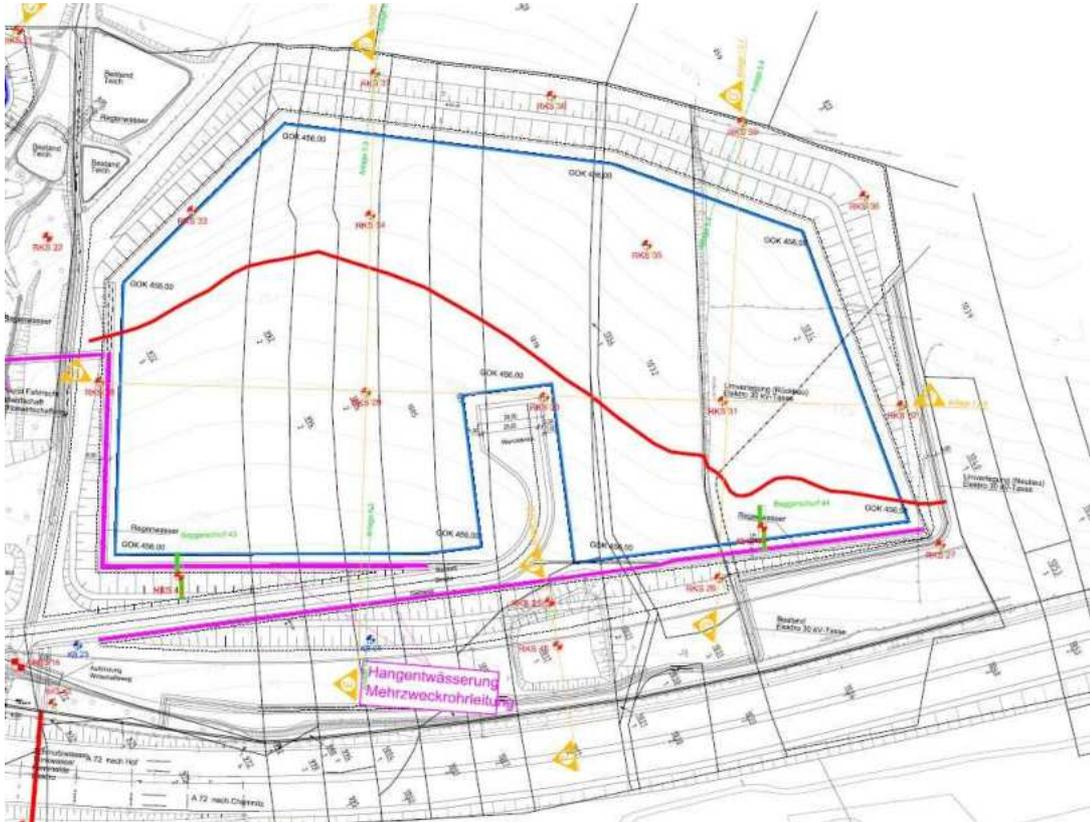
Planausschnitt der Baugrunduntersuchungen (IB Eckert 09/2019)
